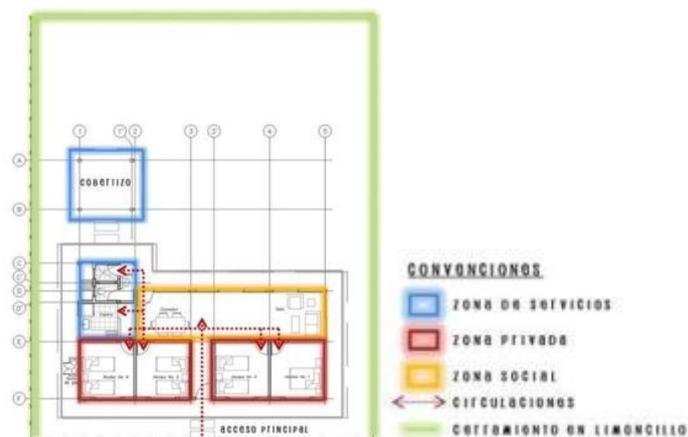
Vista en planta de la Vivienda Tipo 6 diseñada para el Reasentamiento de Santiago y Palacio
